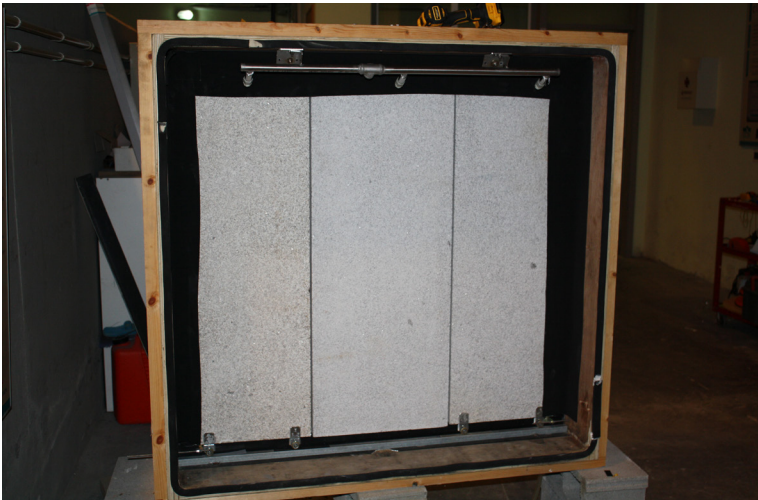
Imagen de la línea de boquillas de proyección de agua en prototipo de fachada ventilada con junta vertical.
